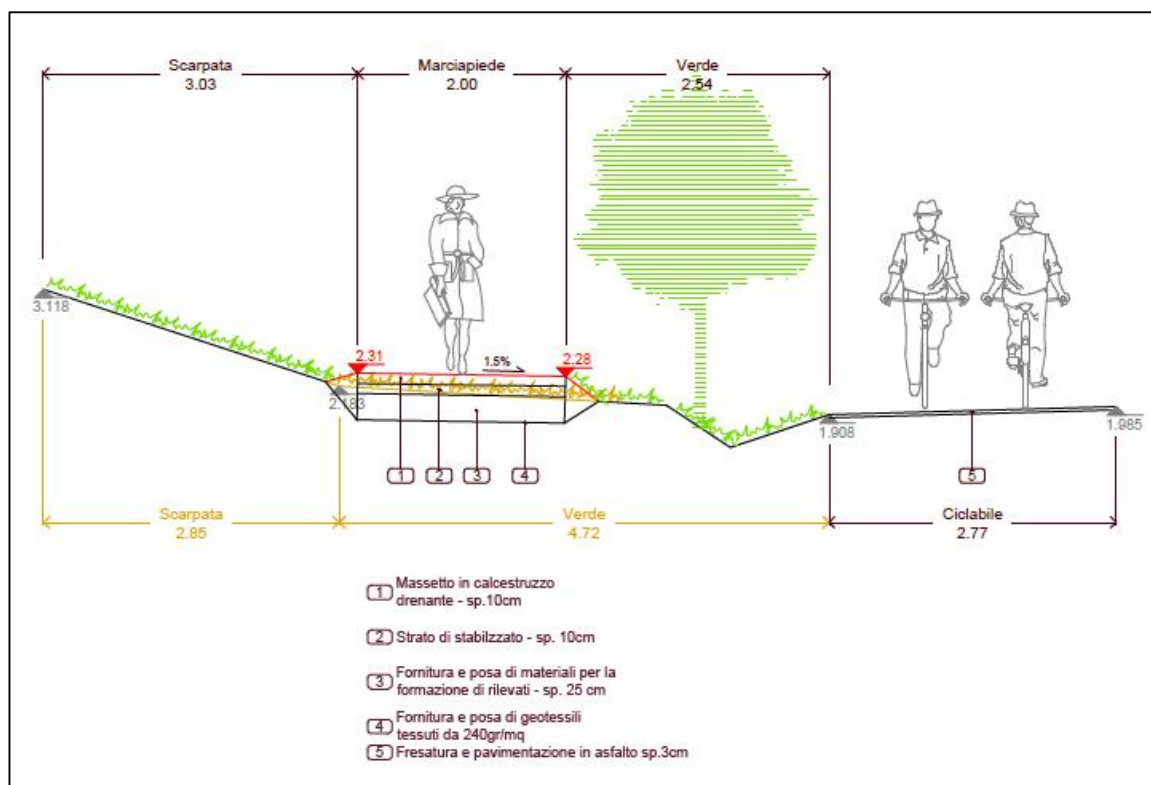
Sezione 14 di progetto trasversale SP delle Collacchie
